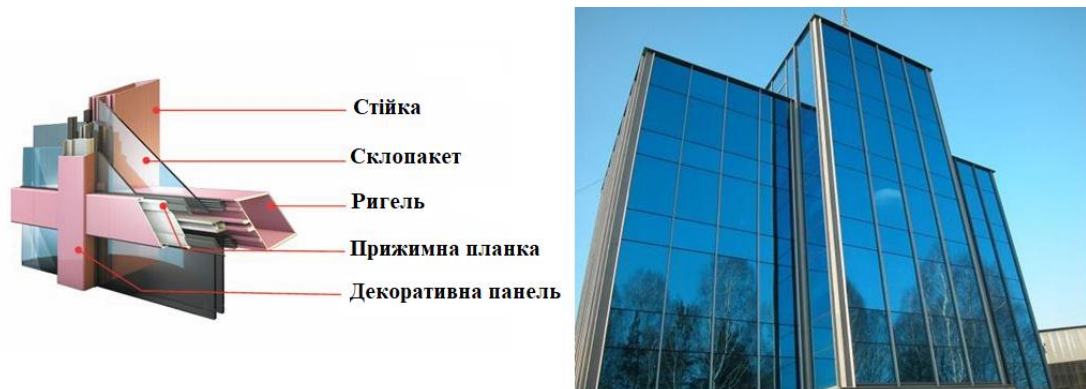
Приклад вузла кріплення стійко-ригельних конструкції для скляних фасадів та приклад змонтованого фасаду будівлі
